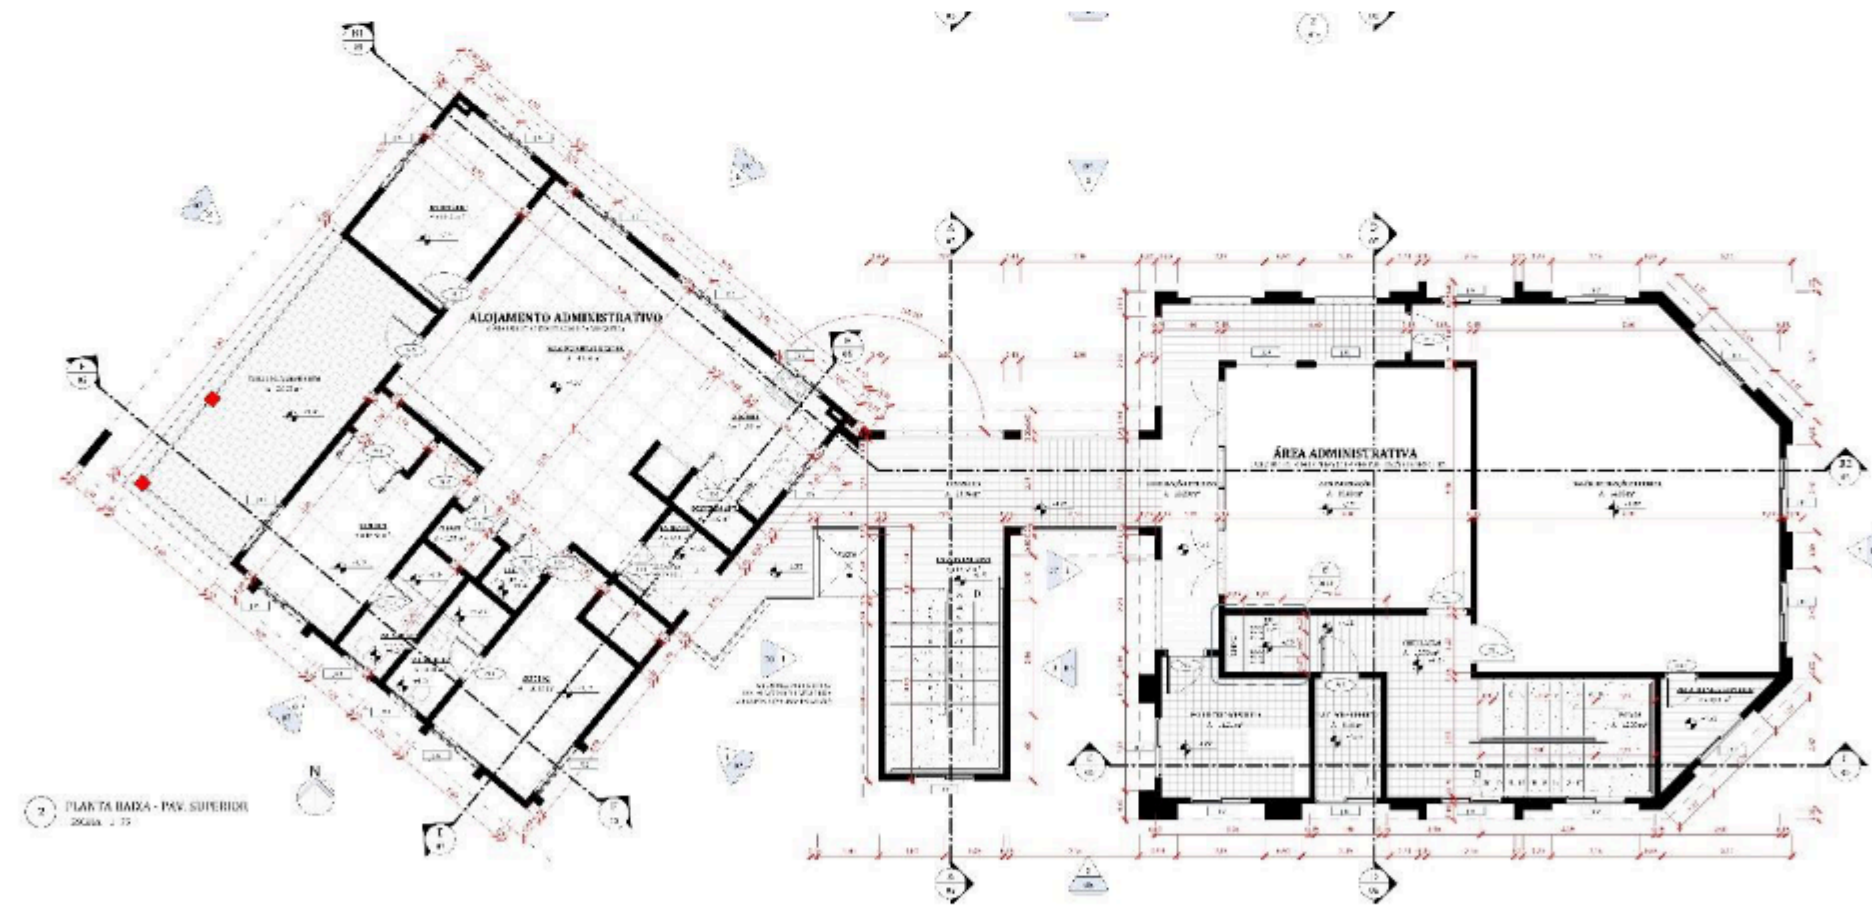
IMAGEM – PLANTA DO PAVIMENTO SUPERIOR
